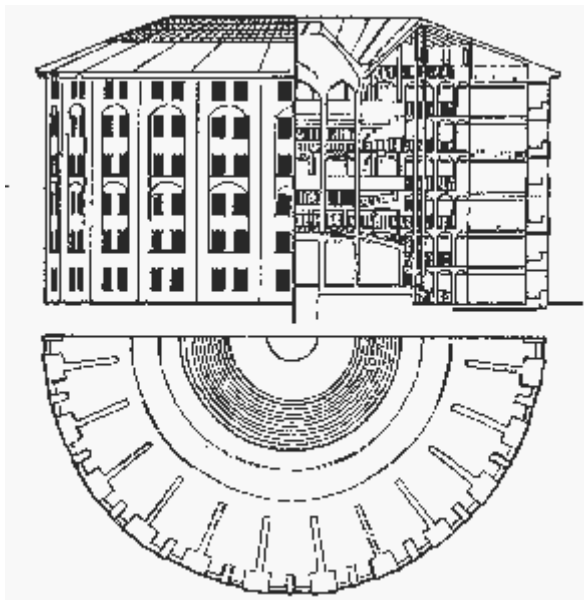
Proyecto para una prisión panóptica: media planta y sección, 1791
